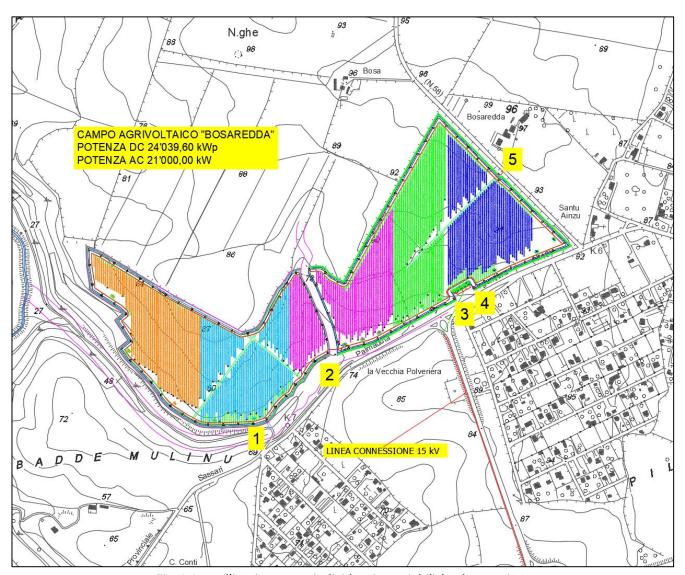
Area d'impianto con individuazione viabilità ed accessi
